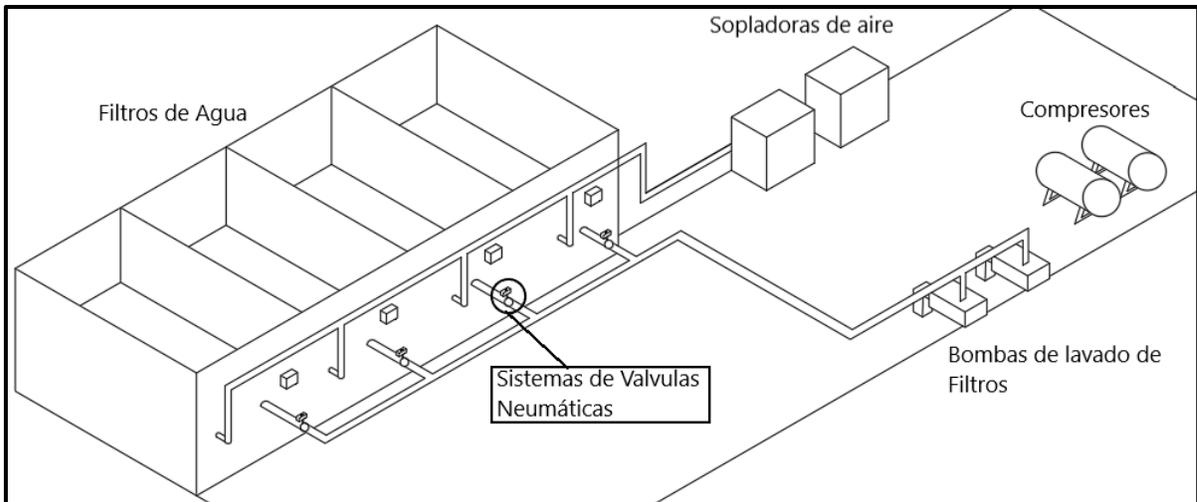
Representación de sistema de lavado de filtros, Planta Potabilizadora Guadalupe
